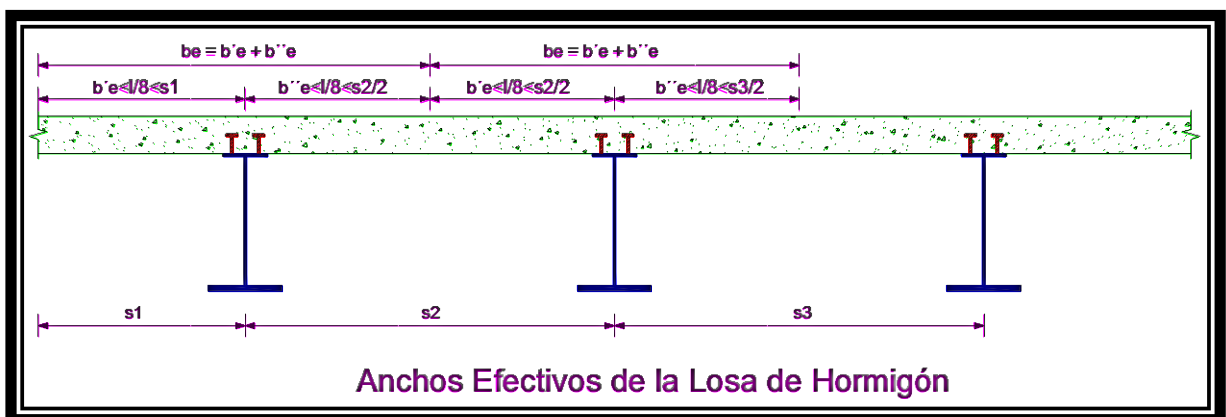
15: Ancho Efectivo de la Losa de Hormigón, según la AISC.
